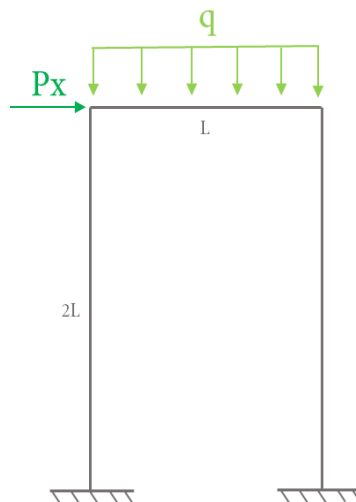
Representação Esquemática do Pórtico 1 e carregamento considerado
